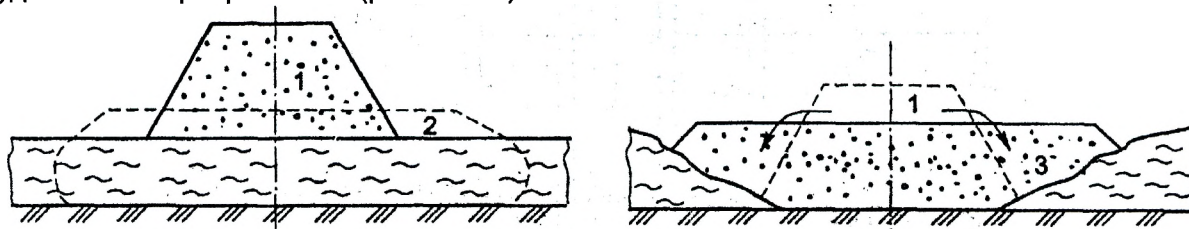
Схема посадки насыпи на дно болота методом перегрузки: 1 – временное сечение отсыпаемой насыпи; 2 – проектное сечение земляного полотна; 3 – реальное сечение земляного полотна после завершения работы
